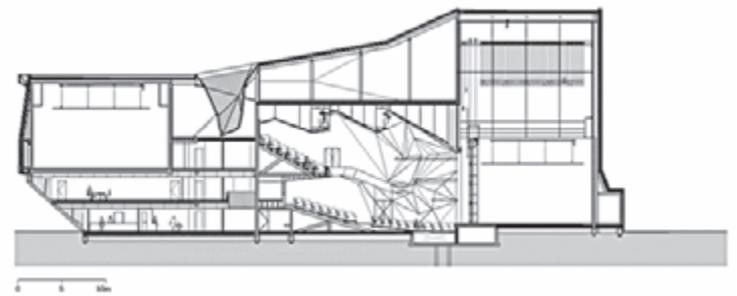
Sezione longitudinale sulla sala maggiore.
